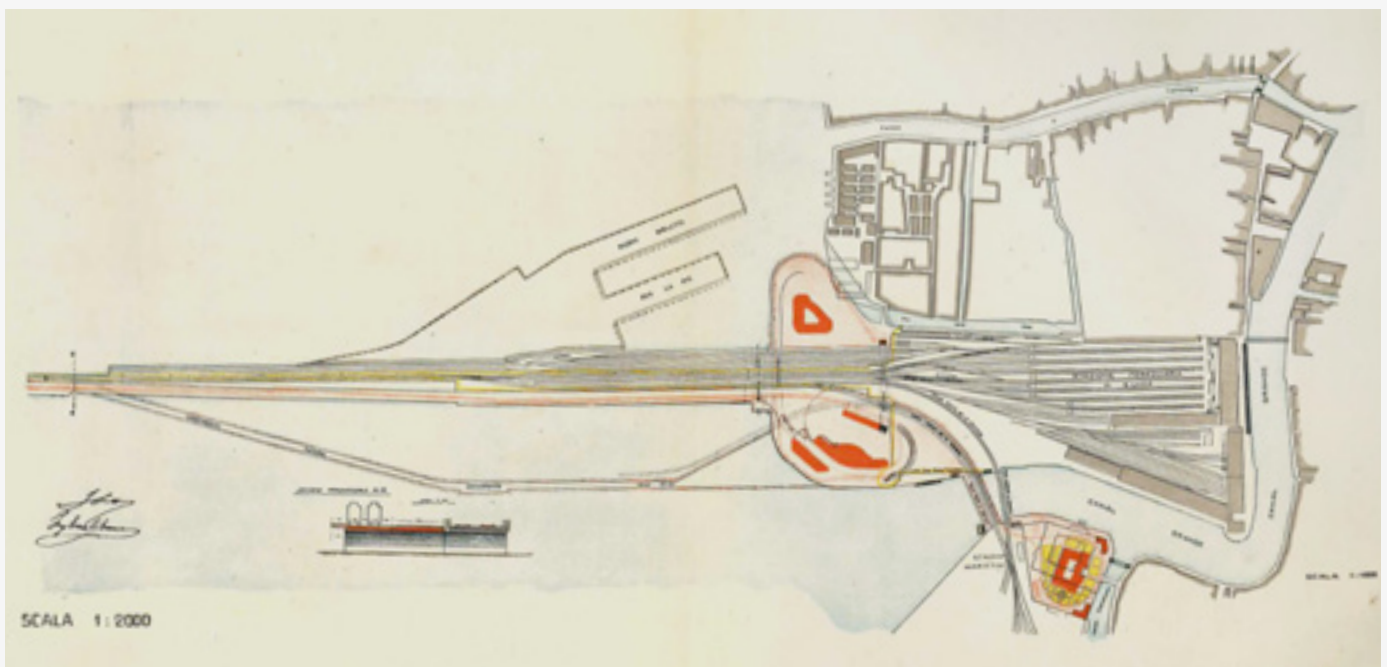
Progetto Emmer-Setti, 1922 per l'allargamento del ponte ferroviario con piazzale di arrivo a Santa Lucia, sul retro della stazione. MIOZZI 1934, p.127
